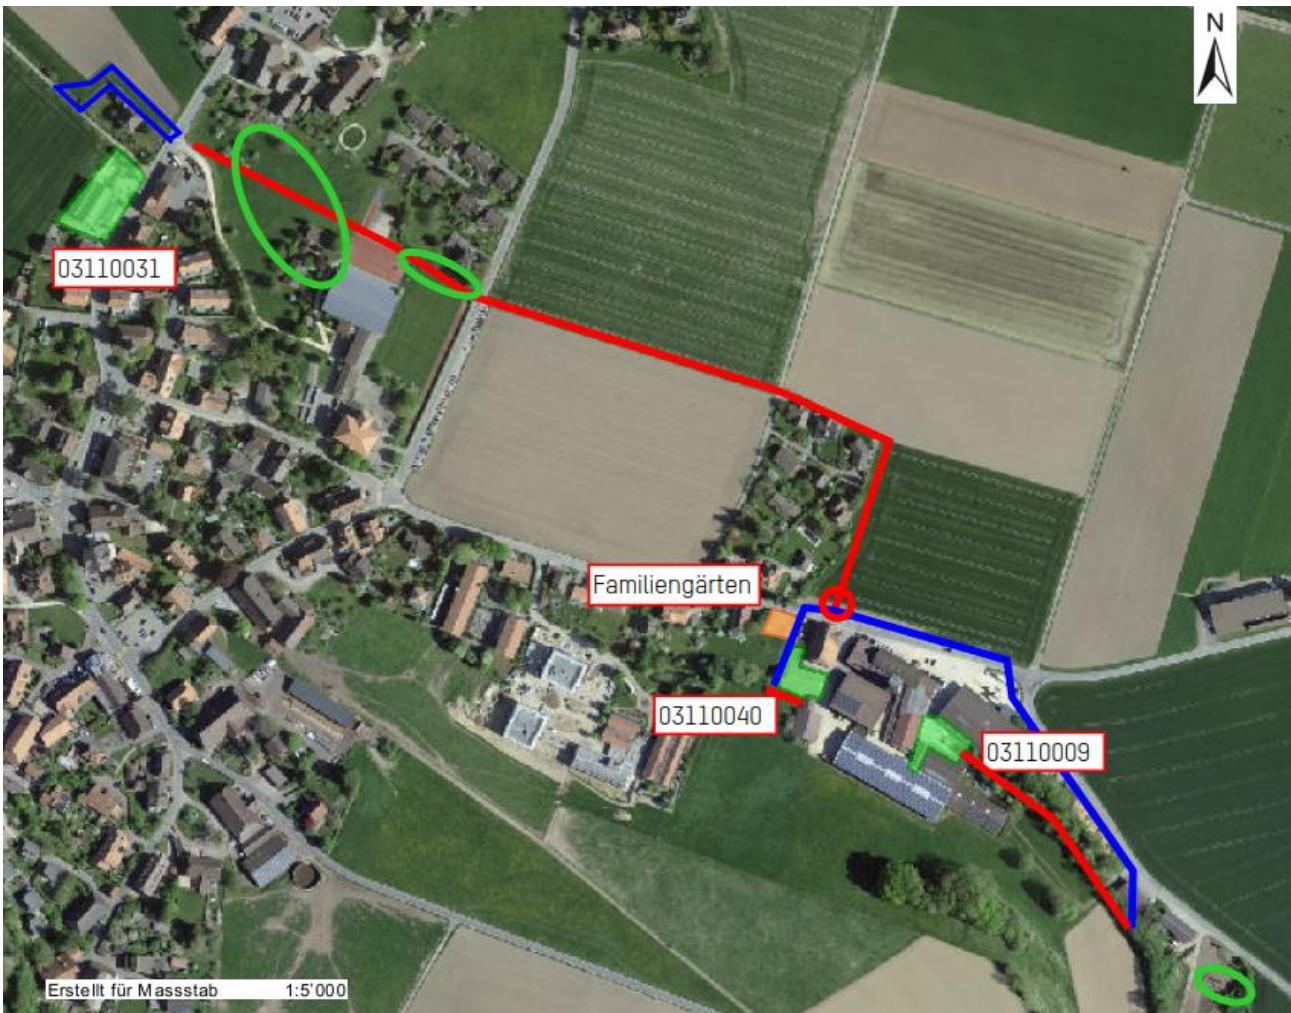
Lage und Bezeichnung der Kbs-Standorte sowie der Verdachtsstandorte für Bodenbelastungen inklusive Bezeichnung. Grüne Flächen: Betriebsstandorte. Orange Fläche: Familiengarten. Rote Linien: Neue Leitung, Blaue Linien: Neues Gerinne, Grüne Kreise: Terrainmodellierungen.
